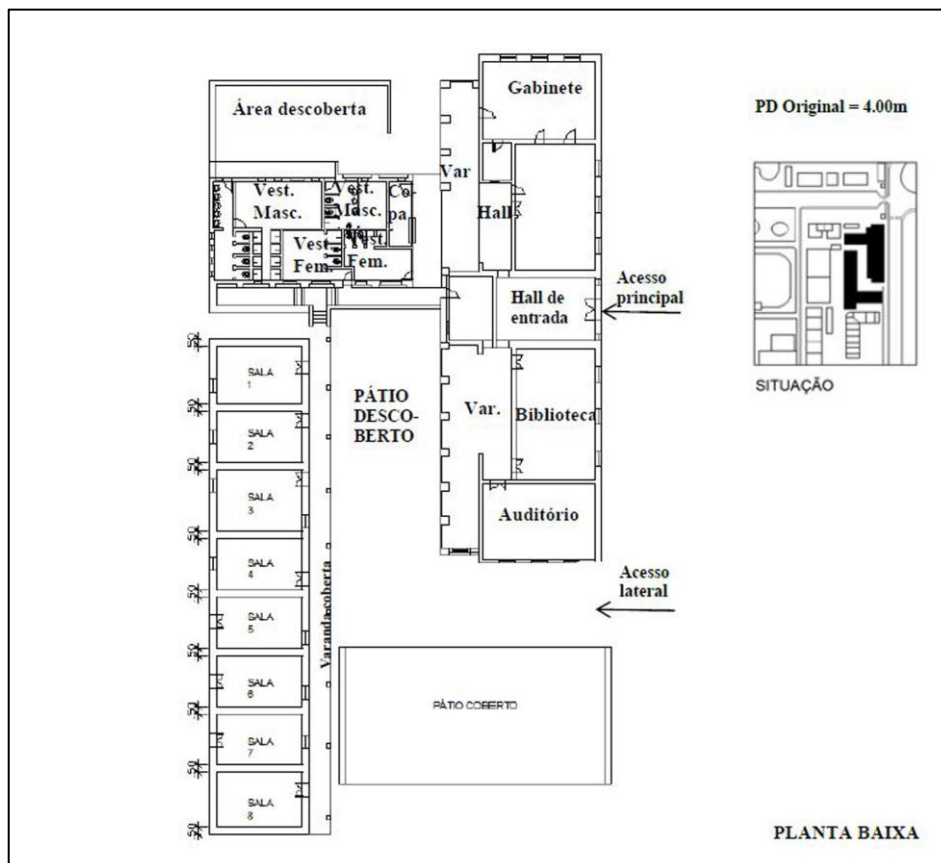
Planta baixa do conjunto da escola Antônio Prado Junior, anterior a ocupação da fundação RIOZOO. Fonte: Planta fornecida pela administração do Riozoo
